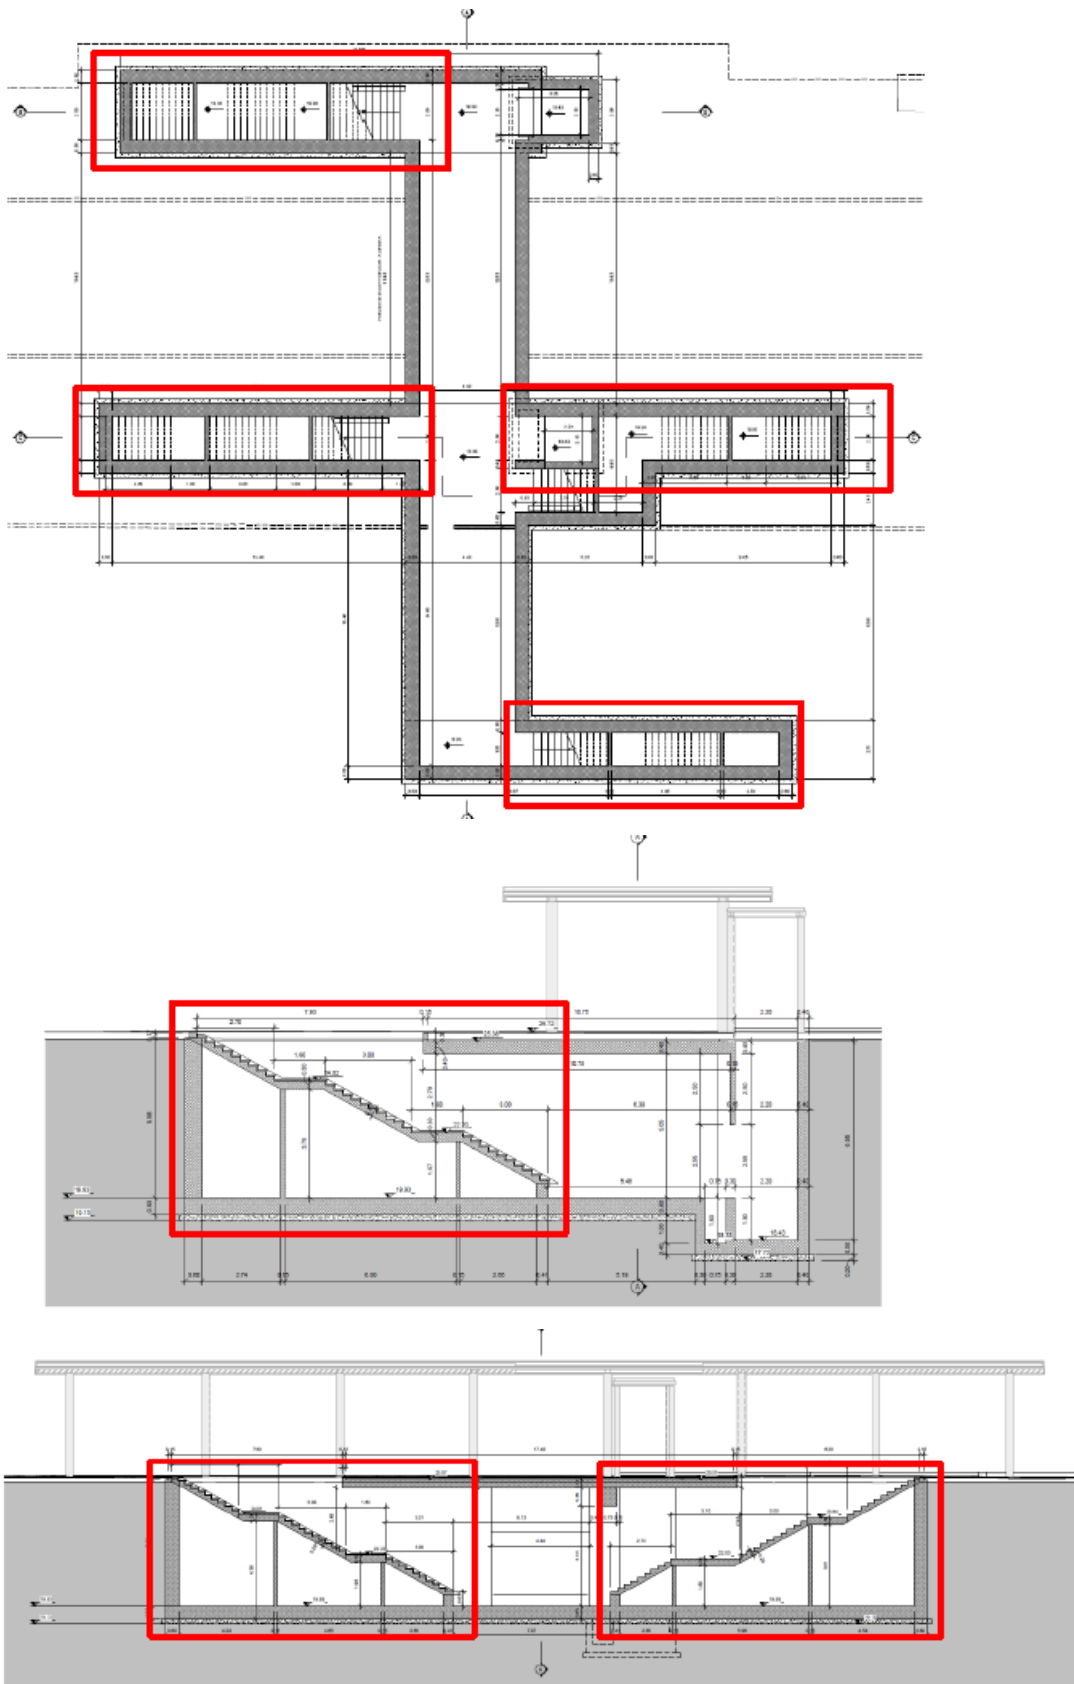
Planimetria dell'opera con attraversamento del sottopasso
